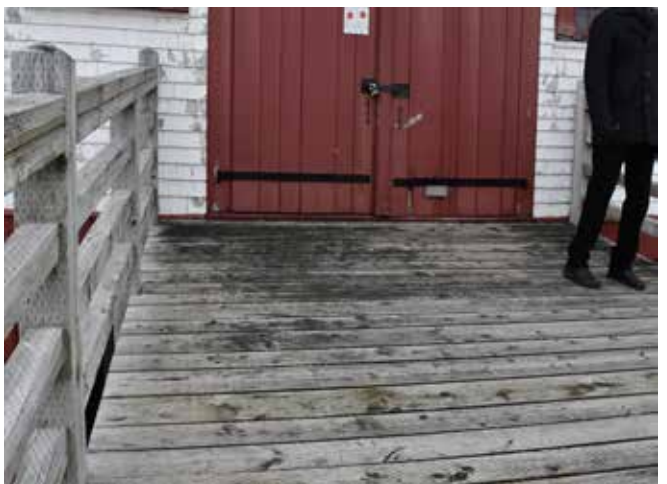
La rampe est construite de poutres et de poteaux en bois traité contreventé entre eux sur lesquels est déposé un platelage de bois.
